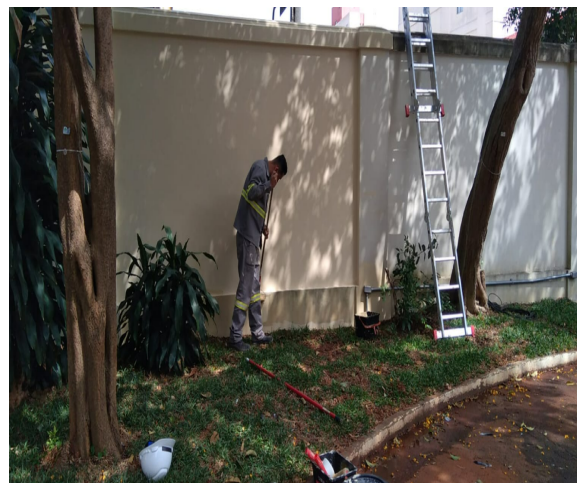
Início da conservação do muro do perímetro, adequação do tom.
